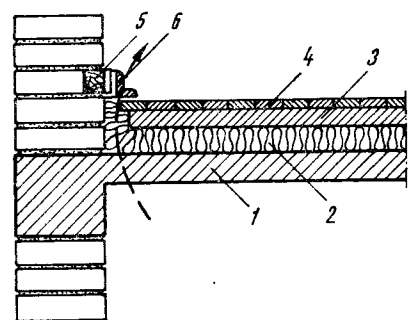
Pardoseală pe dală flotantă: 1 - placă de beton armat; 2 - strat elastic, moale; 3 - dală de beton slab armat în grosime de 3...5 cm; 4 - parchet; 5 - diblu; 6 - pervaz.
